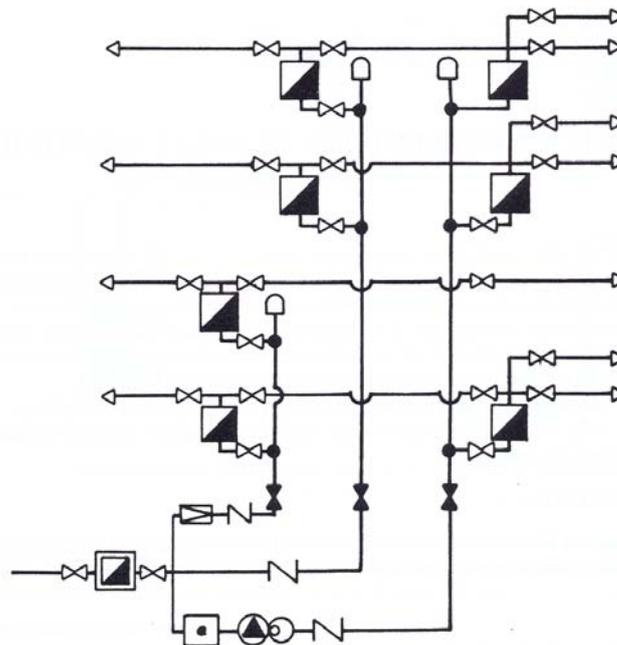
A. Esquema de distribución con contadores por plantas⁶.
